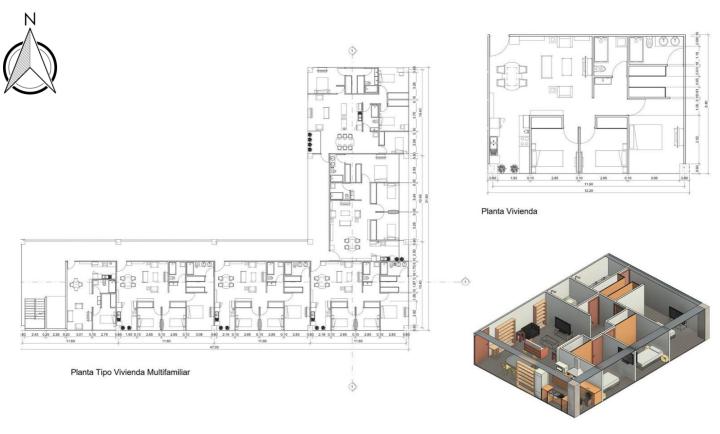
Tercer propuesta de diseño. Plantas e isométrico. Elaboración propia. 2022
